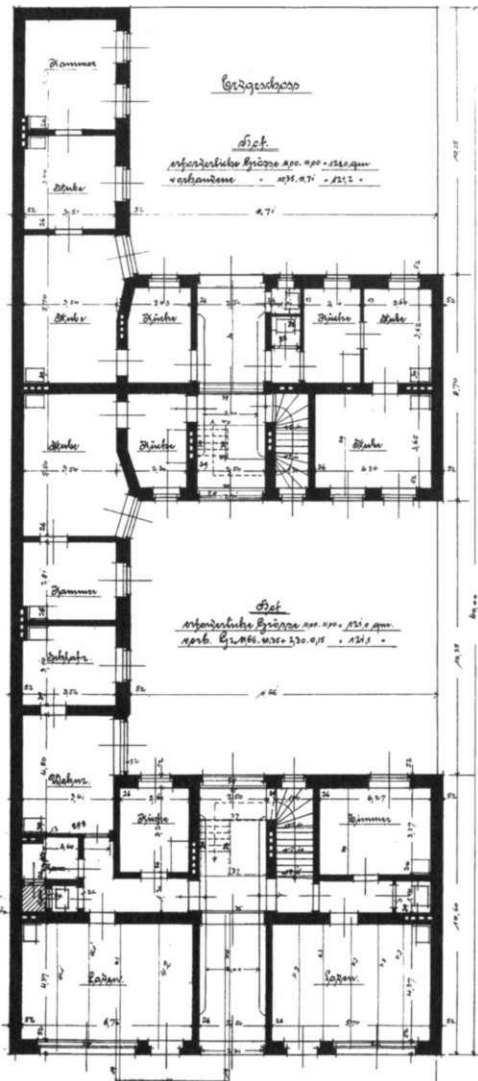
Große Diesdorfer Straße 14, Erdgeschossgrundriß, Typ G
